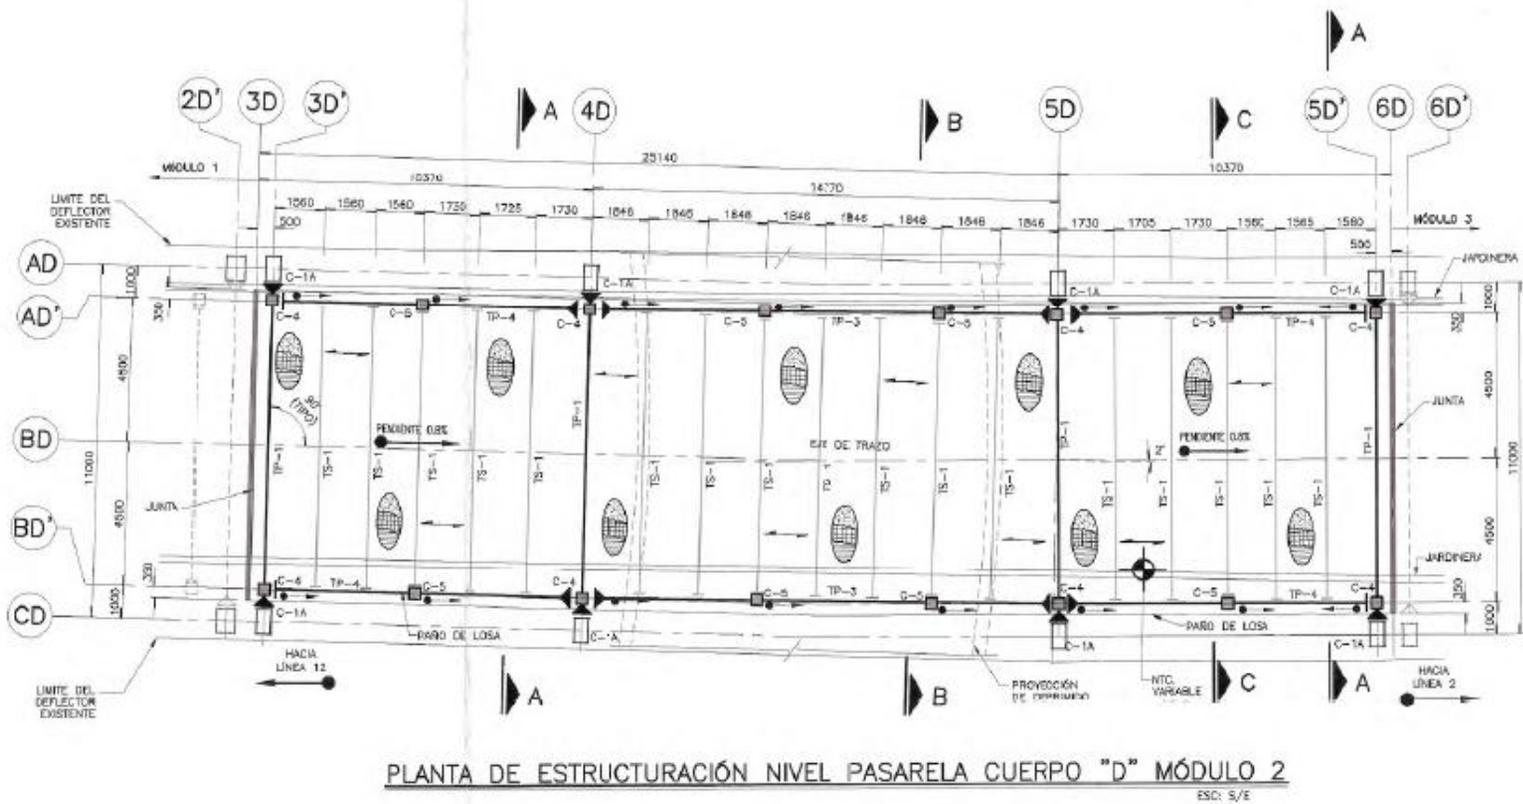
Planta de estructuración nivel pasarela, módulo 2.
